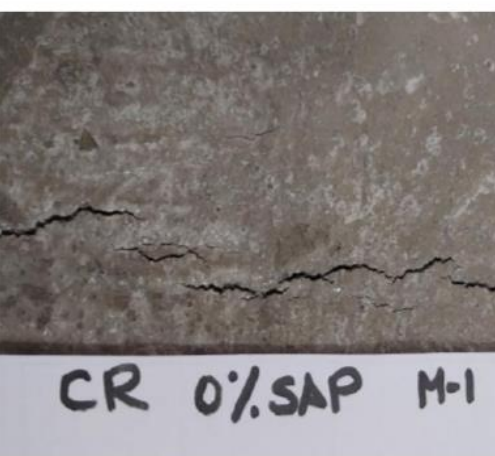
Aparición de fisuras por contracción plástica del concreto sin adición de polímeros super absorbentes.
